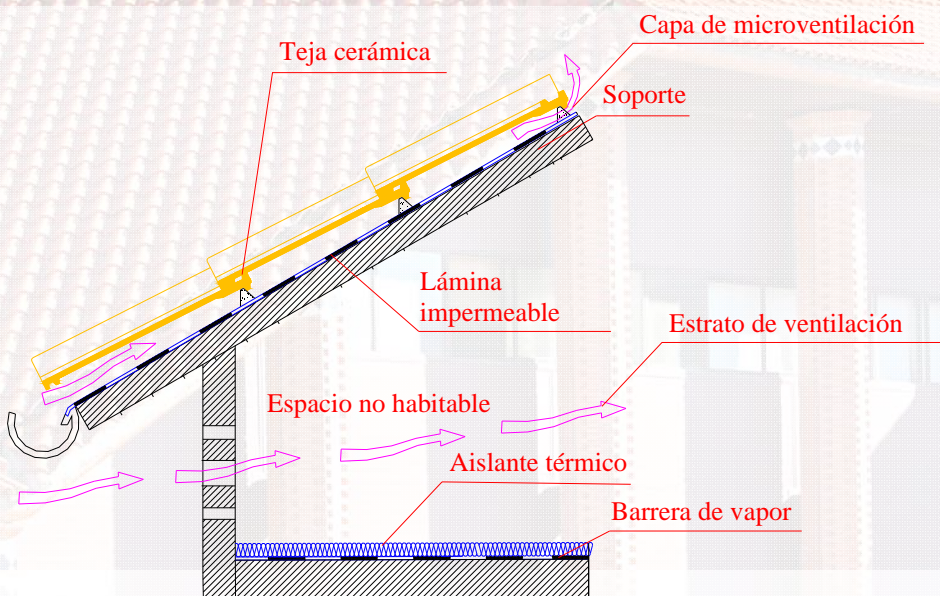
Cubierta aislada y ventilada (espacio bajocubierto no habitable)
